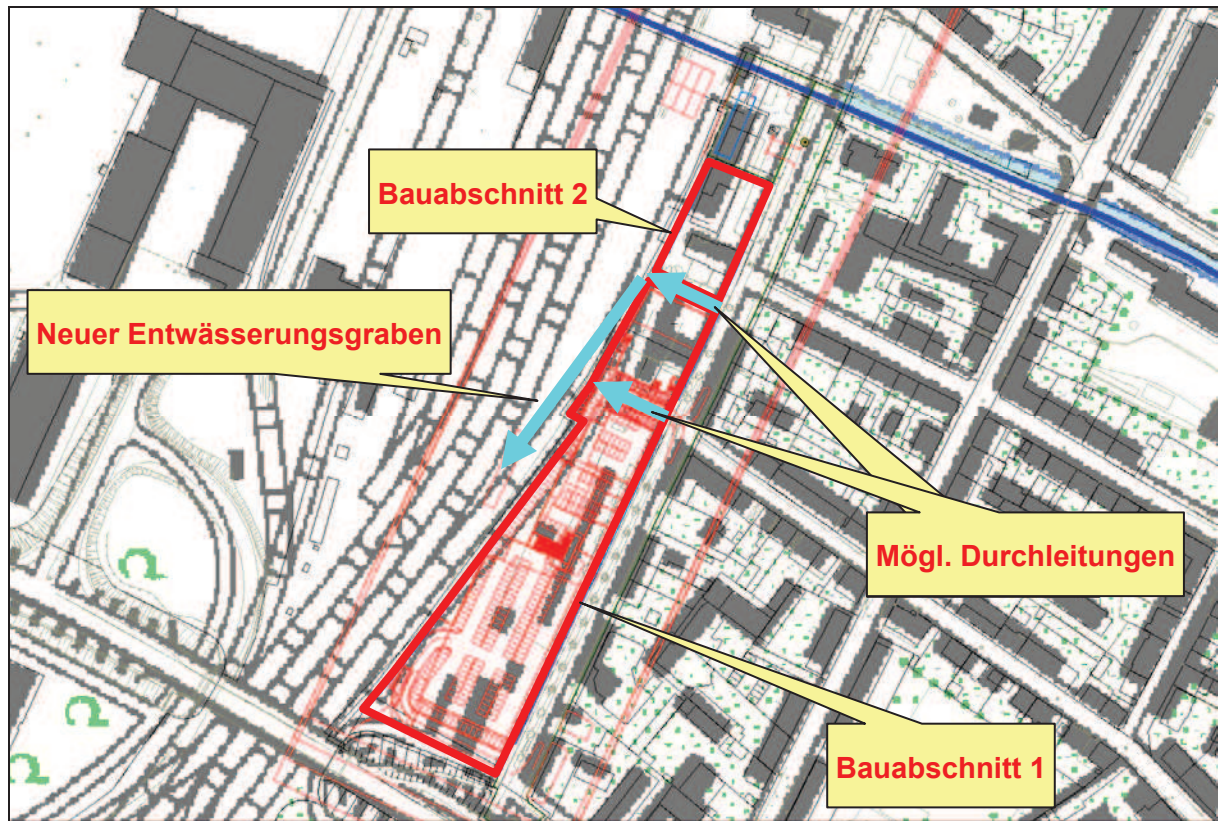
Geplante Neubebauung im Bereich der Prinz-Wilhelm-Straße (Quelle: Bebauungsplan der Stadt Bruchsal)
